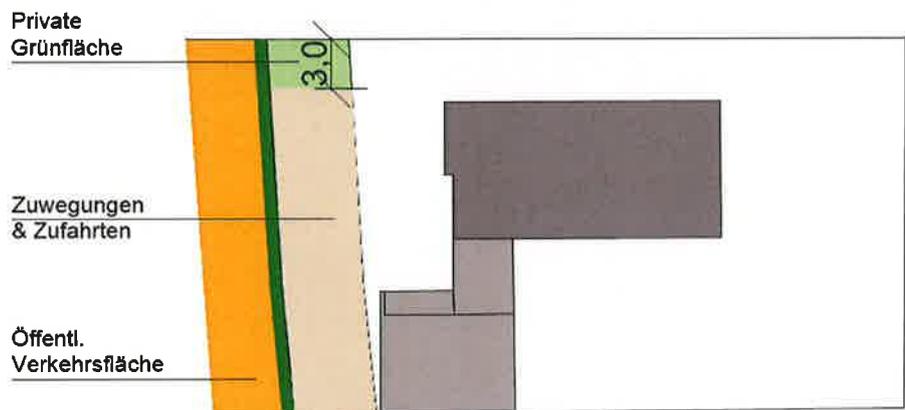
Überdeckung der Grünflächen (Vorgarten) – Maximal zulässige Breite bei anderen Anlagen als Wohngebäude
